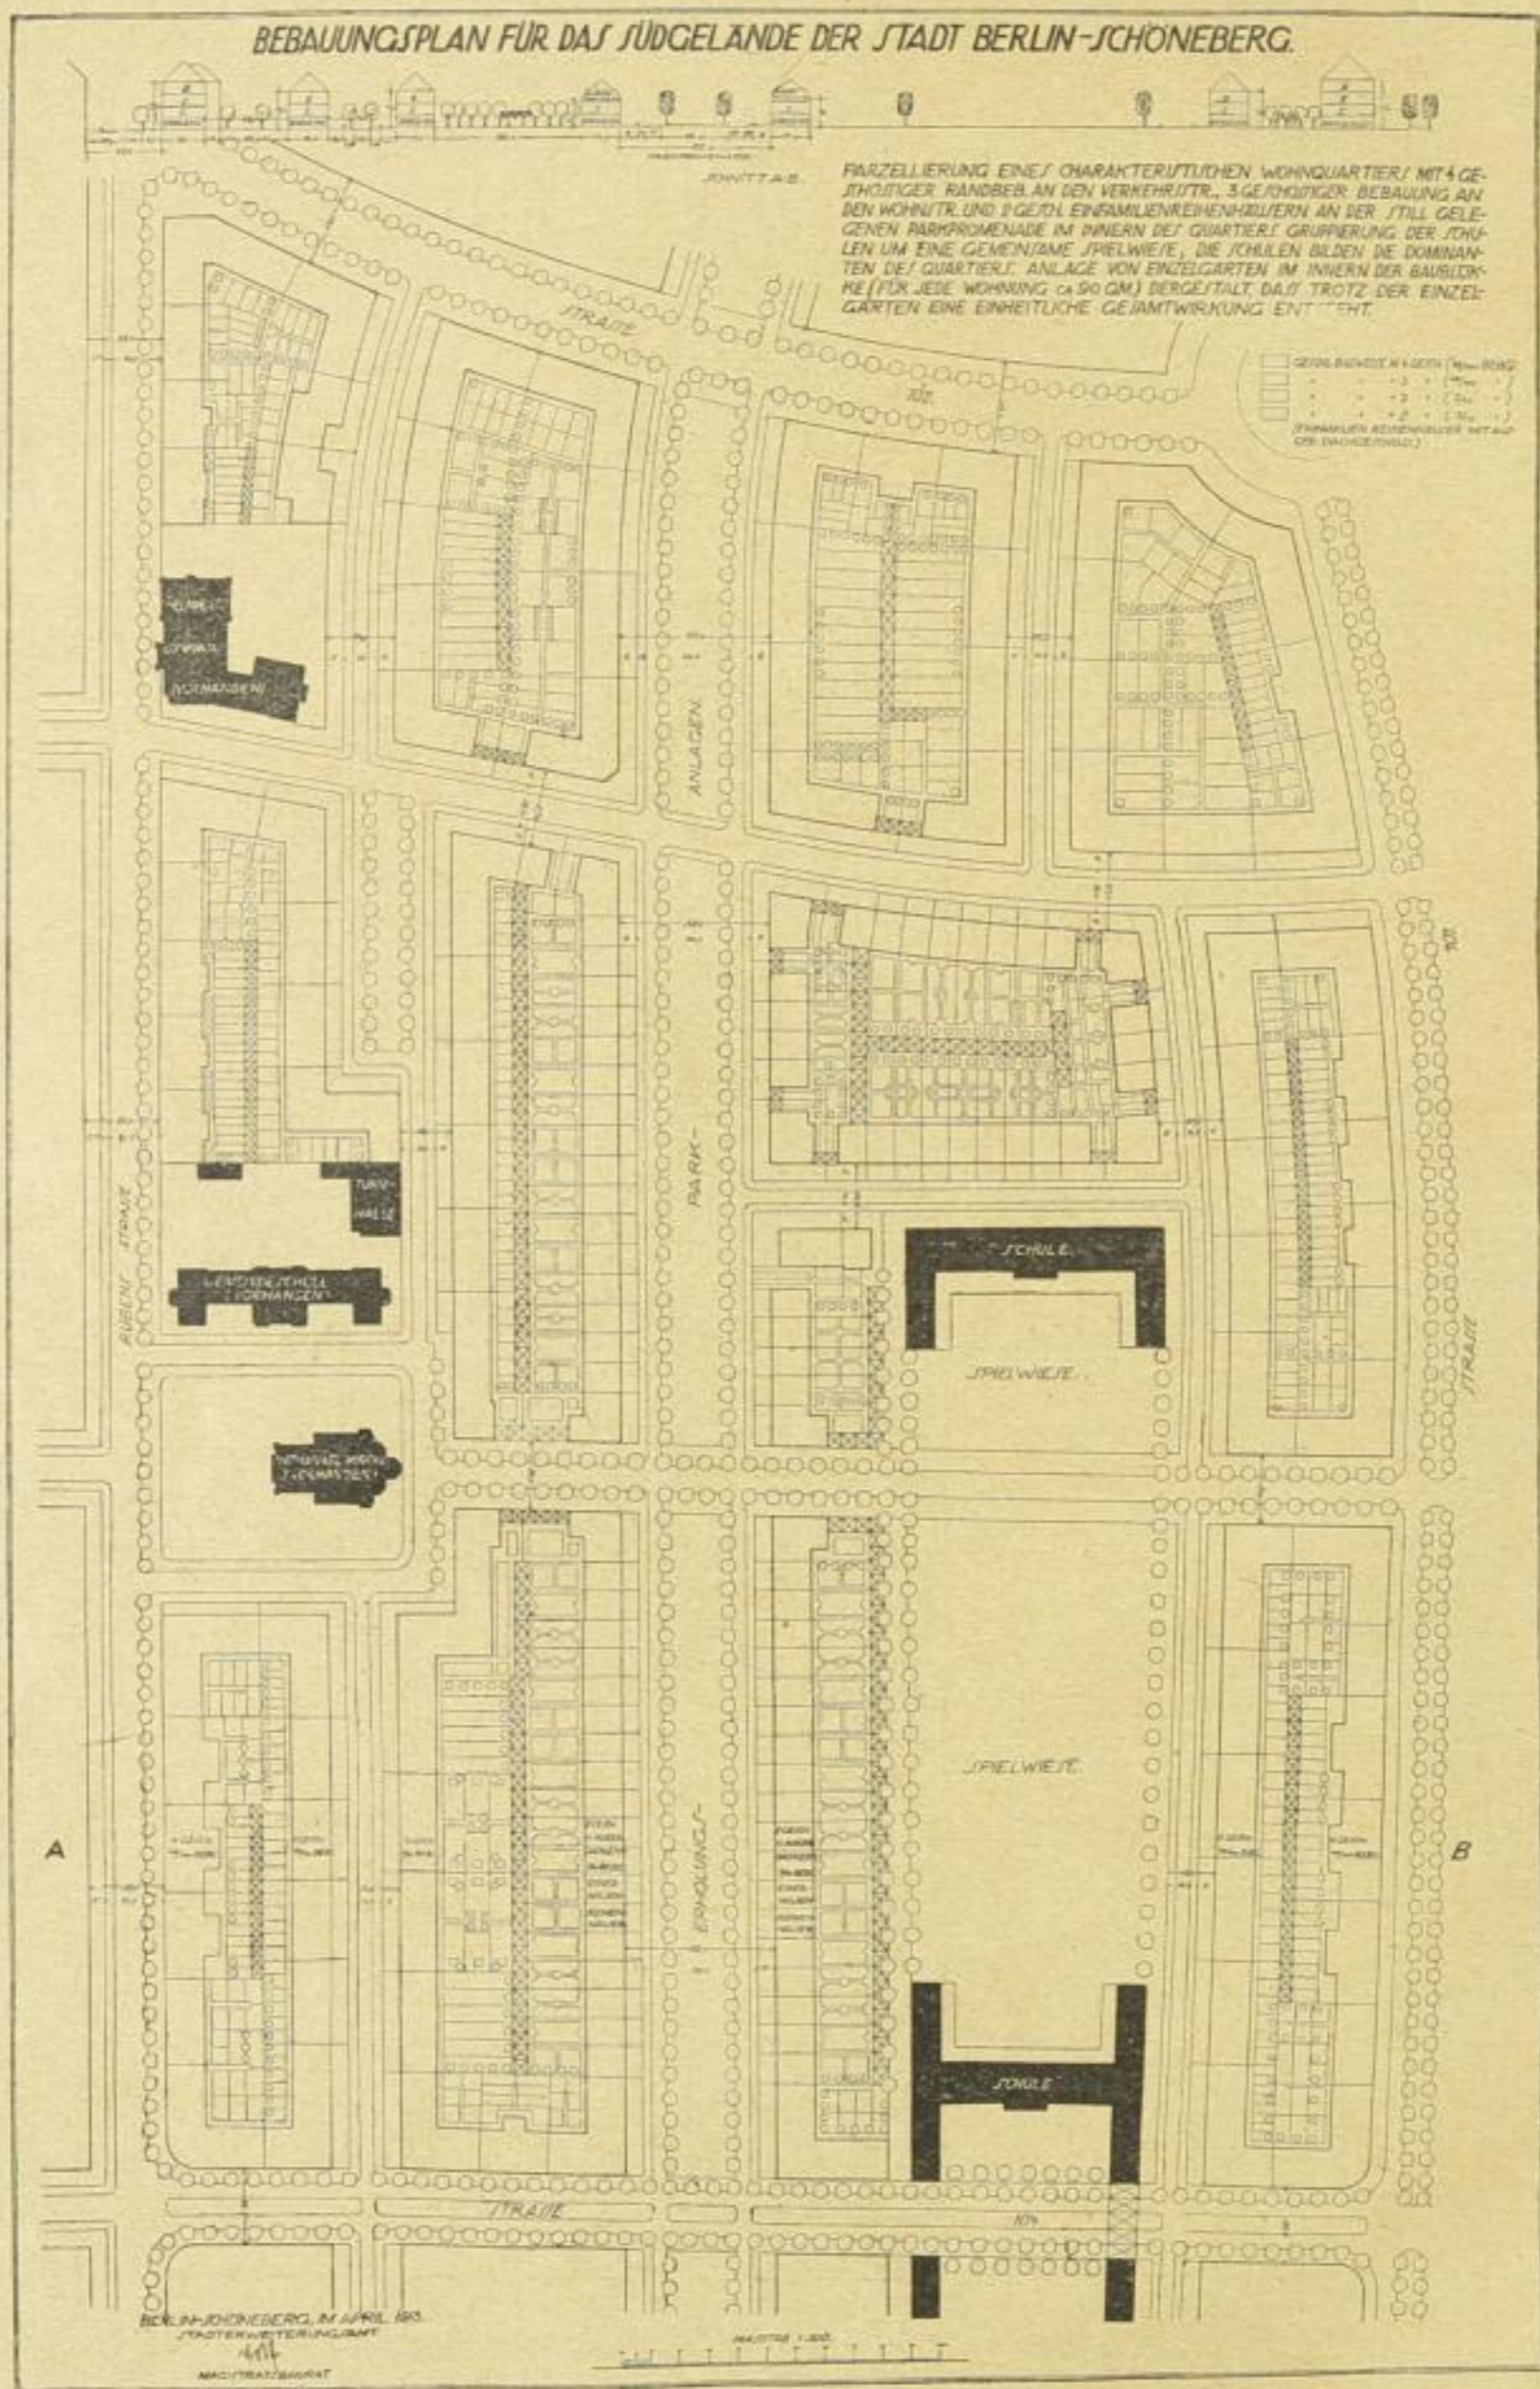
Wohnviertel aus dem Bebauungsplan für das Südgelände in Berlin-Schöneberg.
